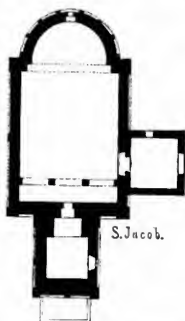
Grundriss der Kirche von St. Jakob. (Nach Wocel.)
